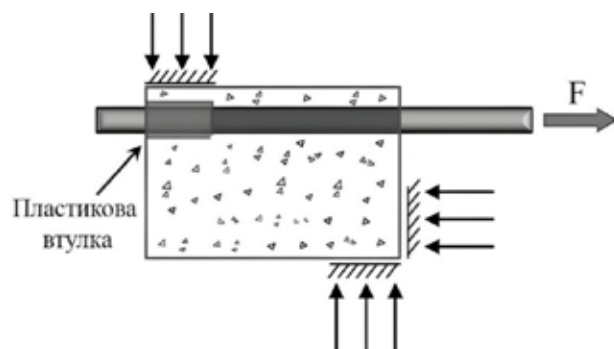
Схема випробування кінців балок для дослідження зчеплення арматури з бетоном [2; 7]
